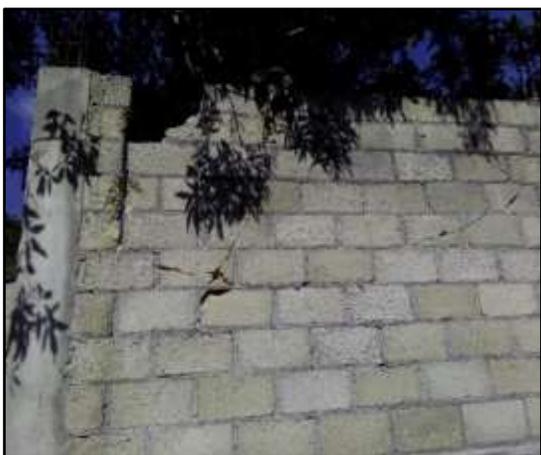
Diversas afectaciones en las construcciones a manera de fracturas y grietas en la iglesia de San Simonito y otras construcciones de casas de la población afectadas por el sismo de septiembre de 2017.
